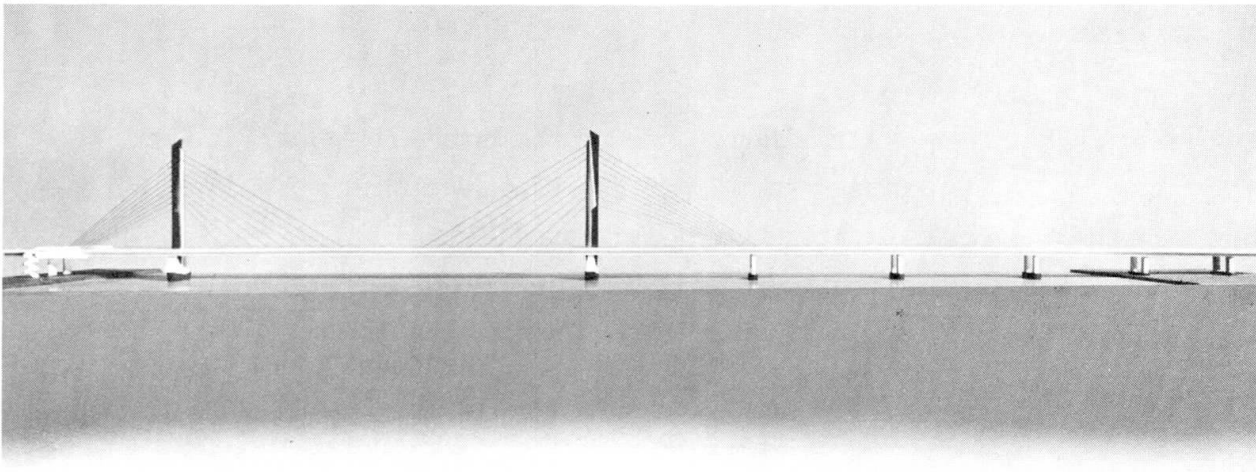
Schrägseilbrücke - Vielseilsystem mit gleichbleibendem Balken
